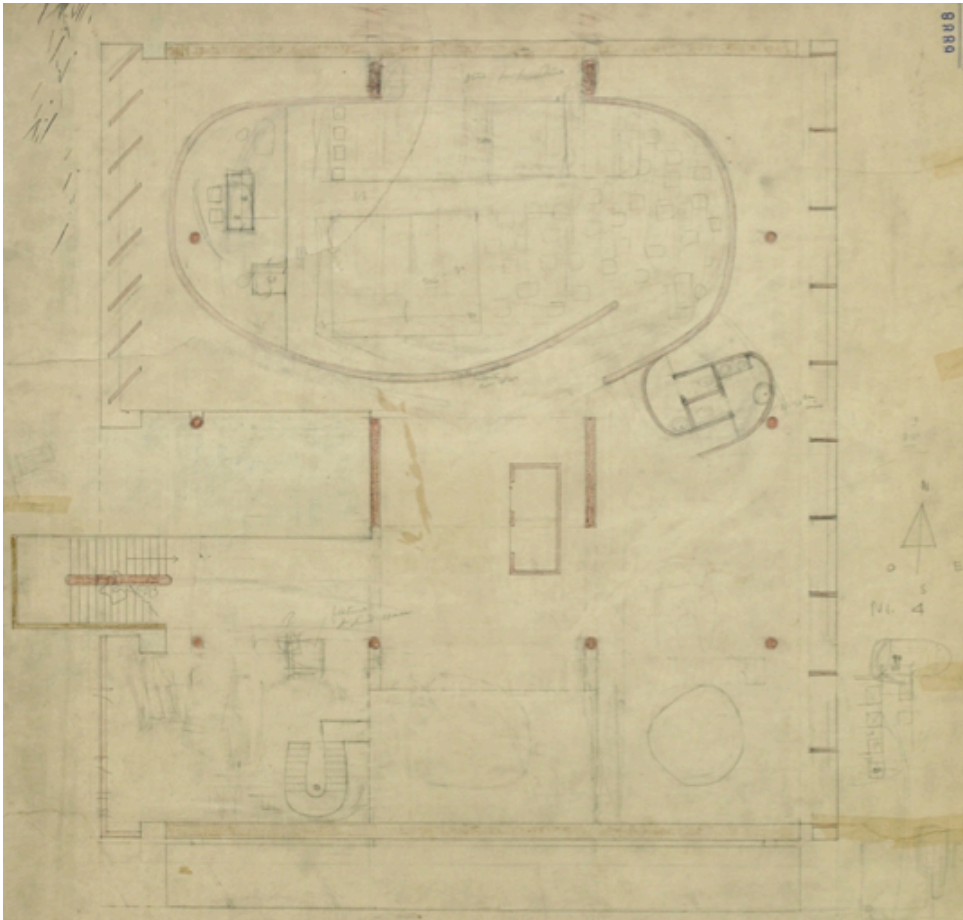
Boceto de planta con la introducción de los brise-soleil. FLC 6888.
